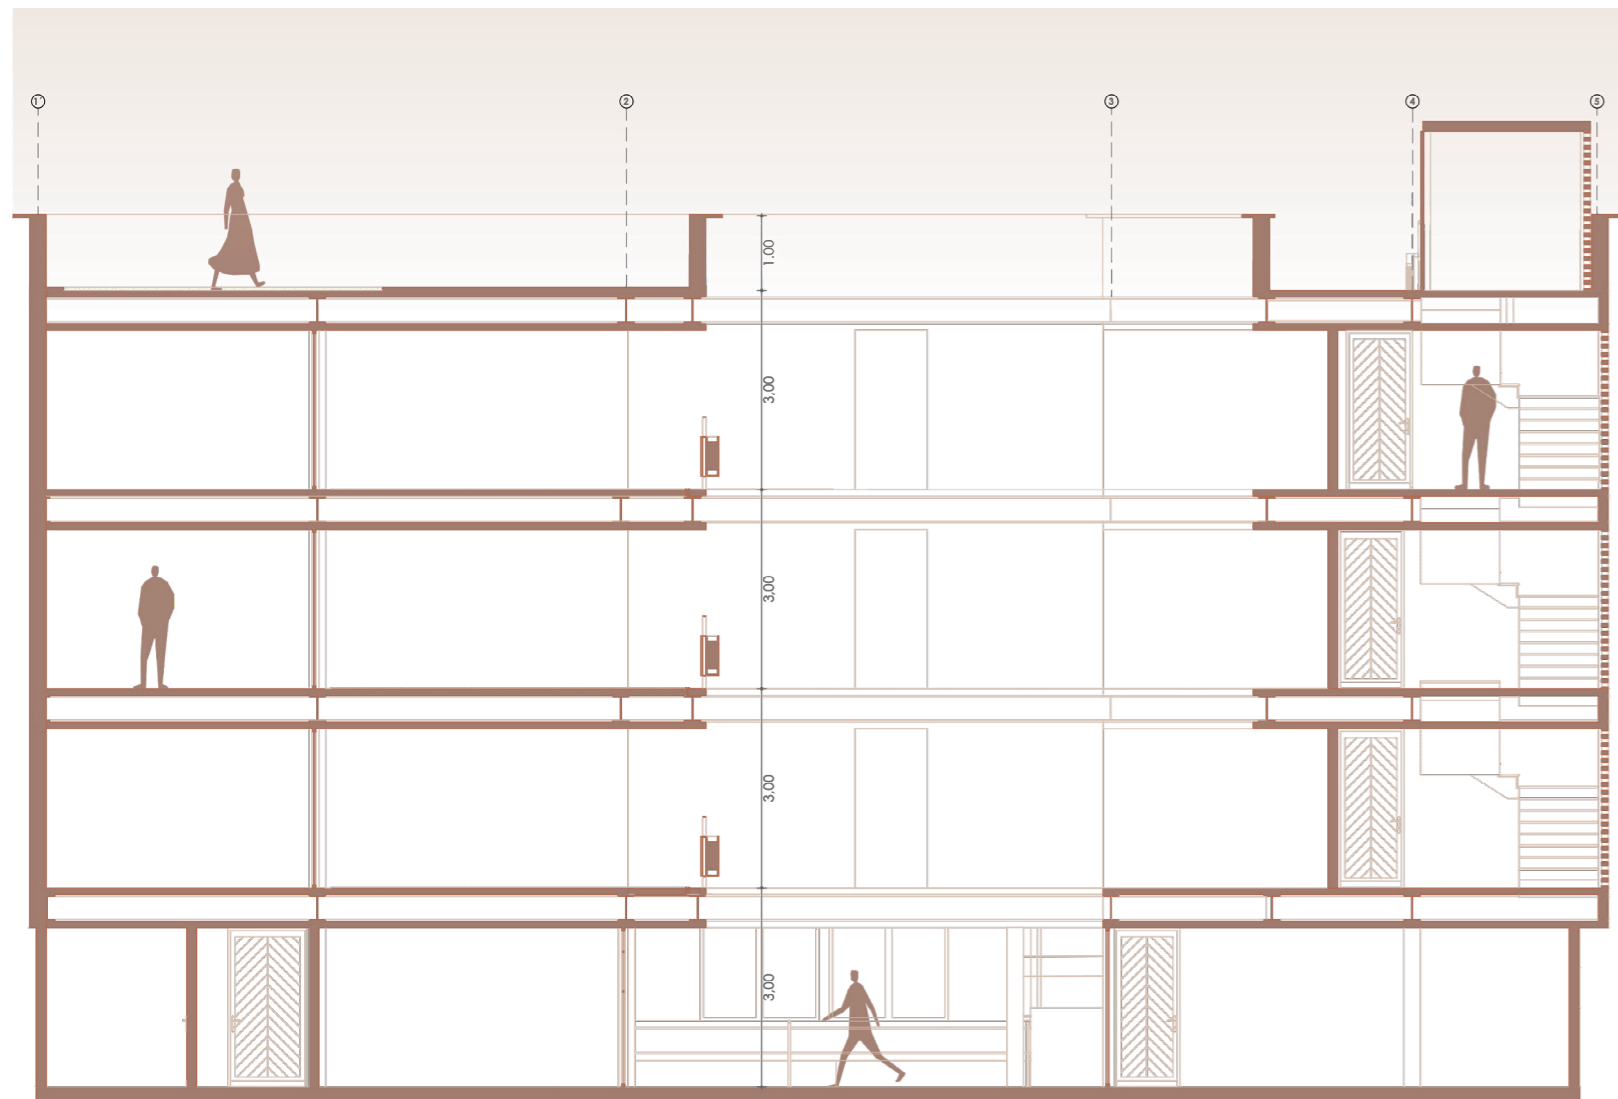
Sección transversal de bloque A. Nota. Elaboración propia.
